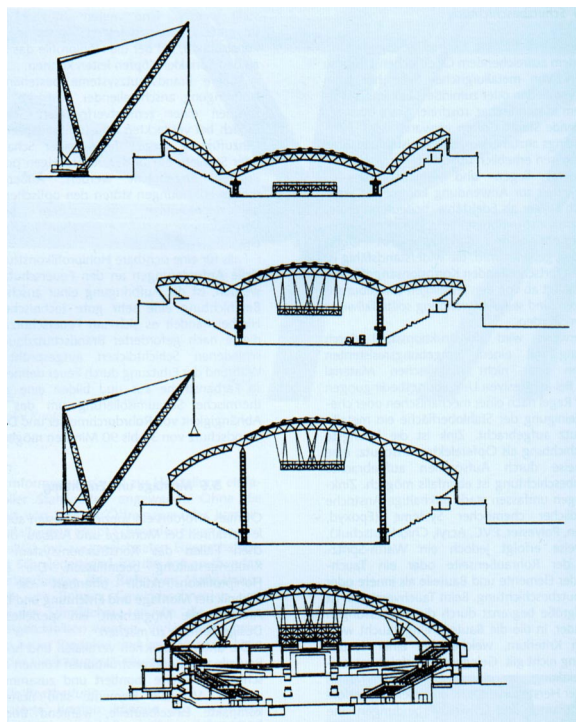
Pavilhão de Esportes Saint Jordi:
